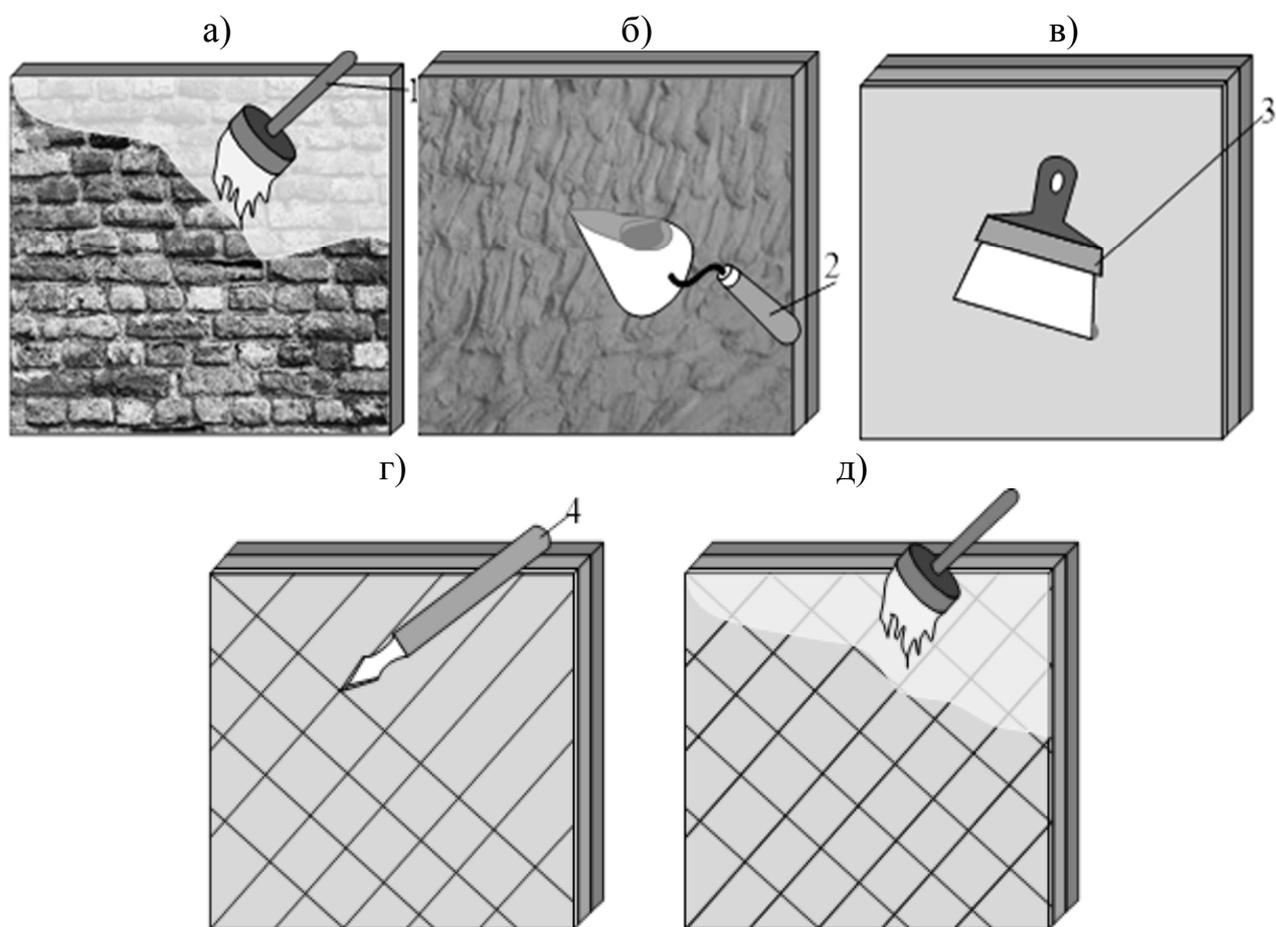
Подготовка поверхности и нанесение подготовительных слоев: а – нанесение грунтовки; б – нанесение обрызга; в – нанесение грунтового слоя; г – нанесение насечек на грунте; д – обработка грунтовкой; 1 – кисть; 2 – кельма (мастерок); 3 – шпатель; 4 – резец
